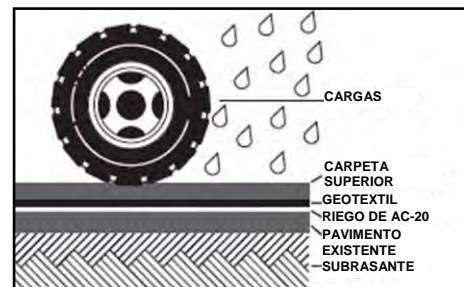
BARRERA PROTECTORA IMPERMEABLE PARA LA SUBRASANTE
